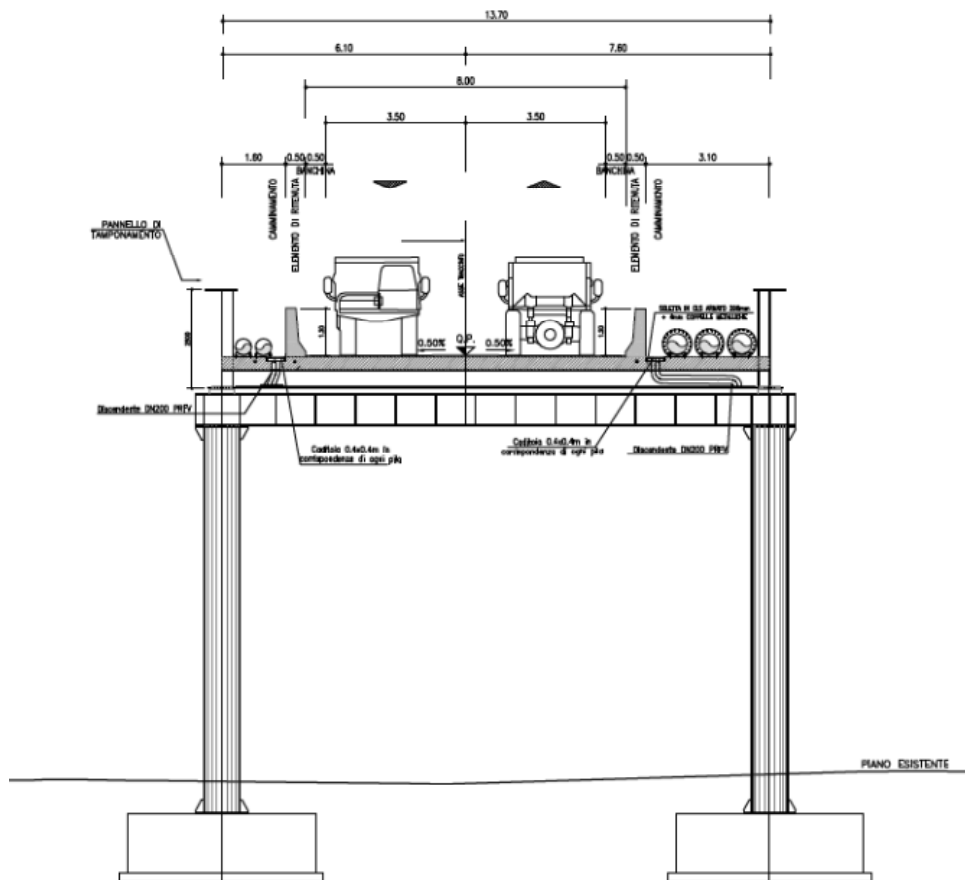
Sezione tipo - Tratto 2 in viadotto acciaio-calcestruzzo
